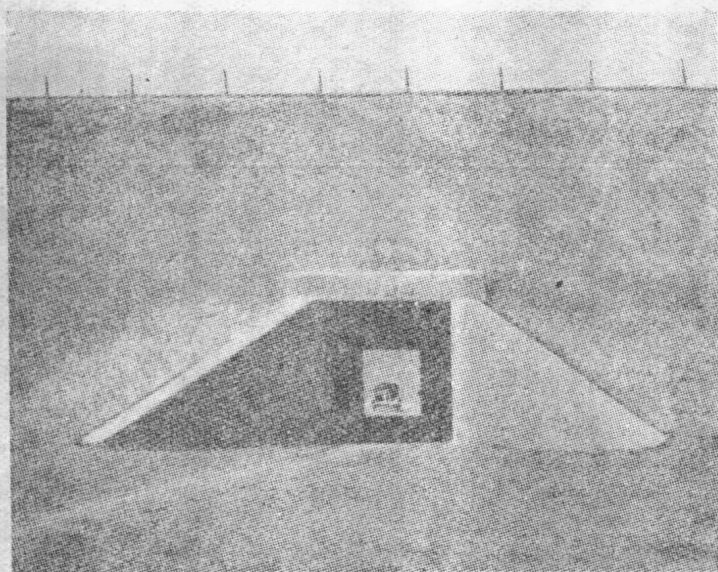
有鋼筋混凝土板梁平頂的混凝土涵洞
